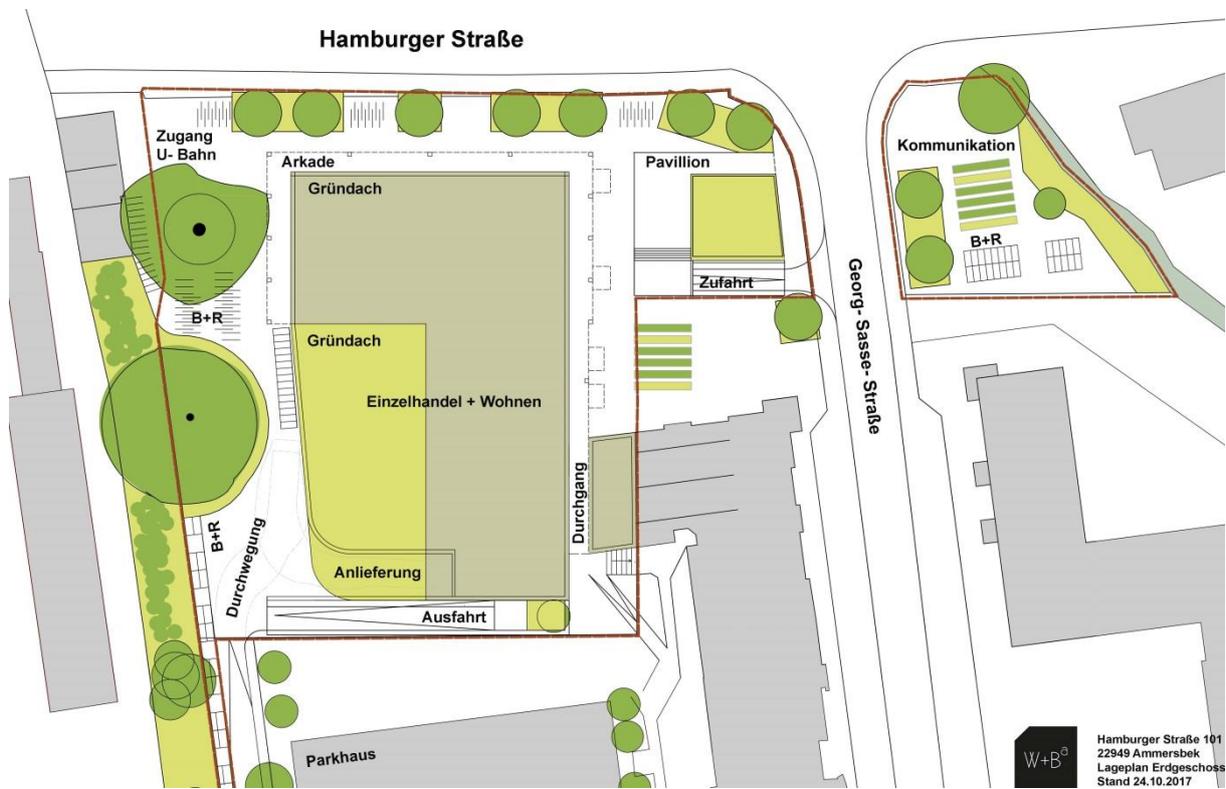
Städtebaulicher Funktionsplan (W+B Architekten, 2017)
